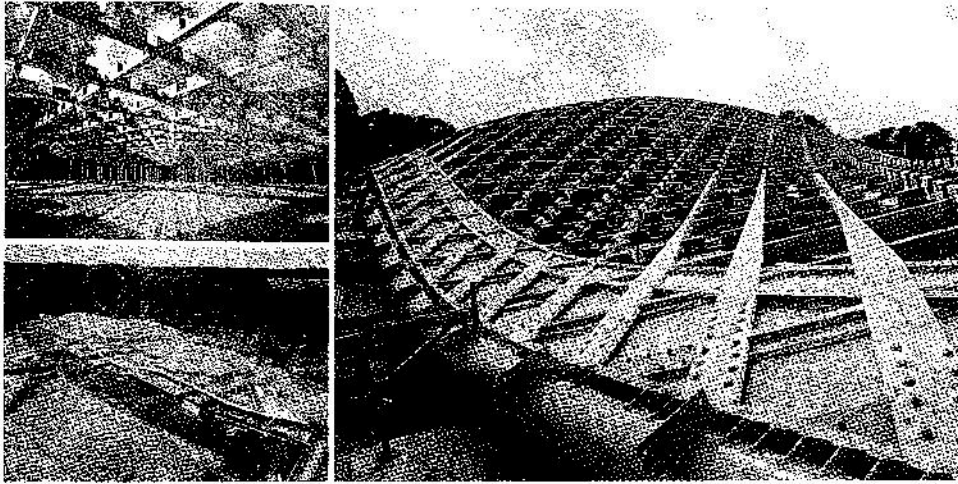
Construção do edifício Savill Garden. Fonte: Glenn Howells Architects
